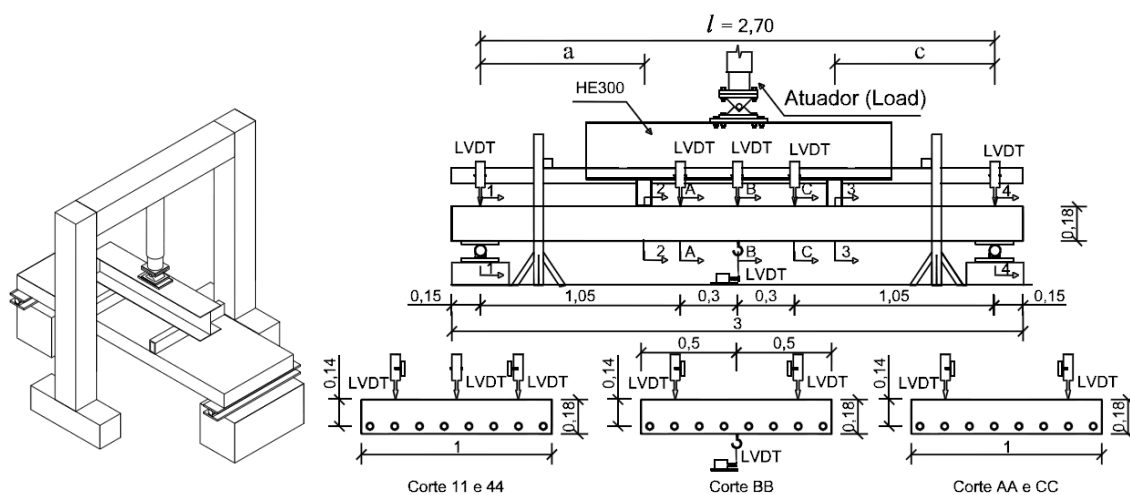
Esquema global de ensaio e instrumentação das lajes. Os cortes 2-2 e 3-3 correspondem aos planos de aplicação da carga. As unidades são expressas em metros.
